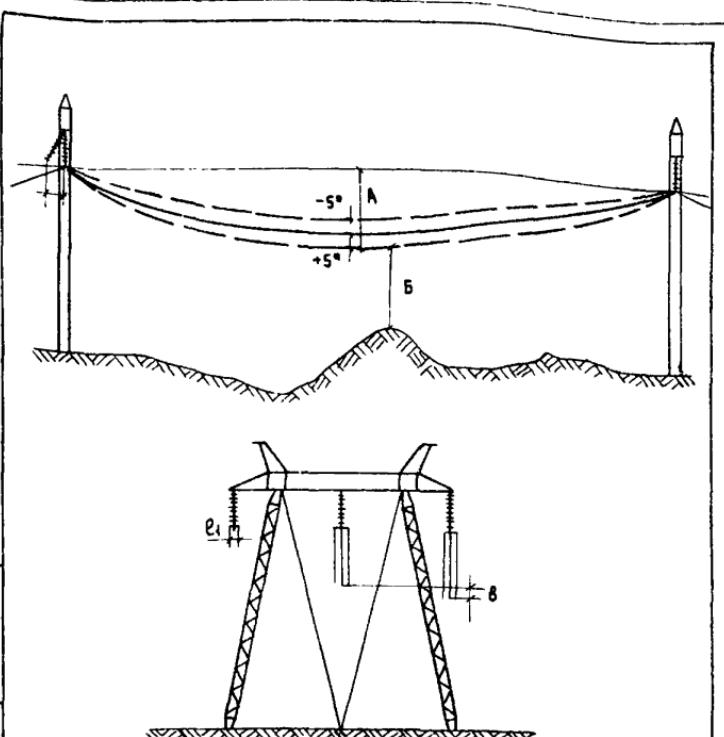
Нормы и допуски на монтаж проводов
